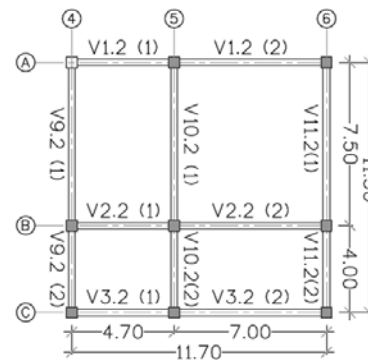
Planta de Identificação das Vigas do Piso 2
